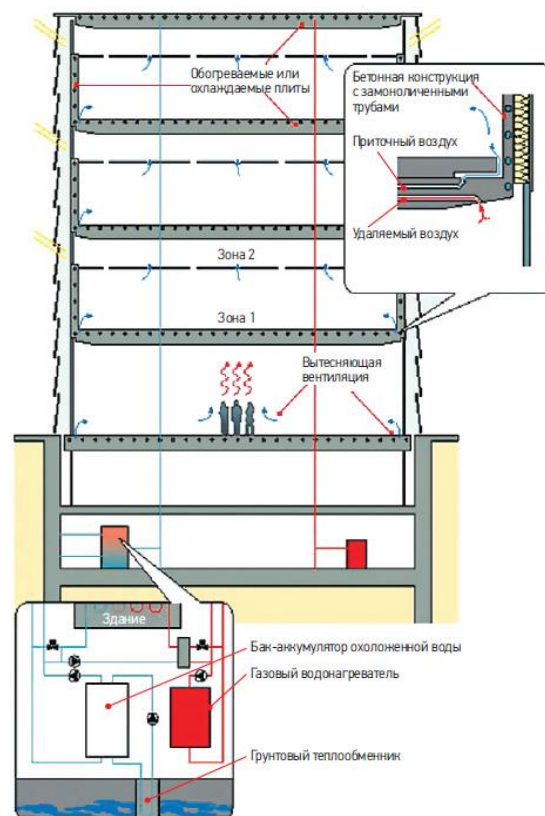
Системы ОВК с термоактивными системами в стенах и бетонных плитах перекрытия для обогрева и охлаждения.
